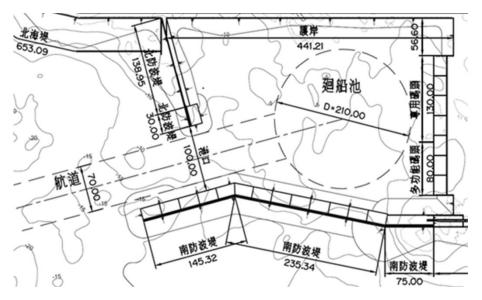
集中式貯存場碼頭及海堤平面佈置示意圖
